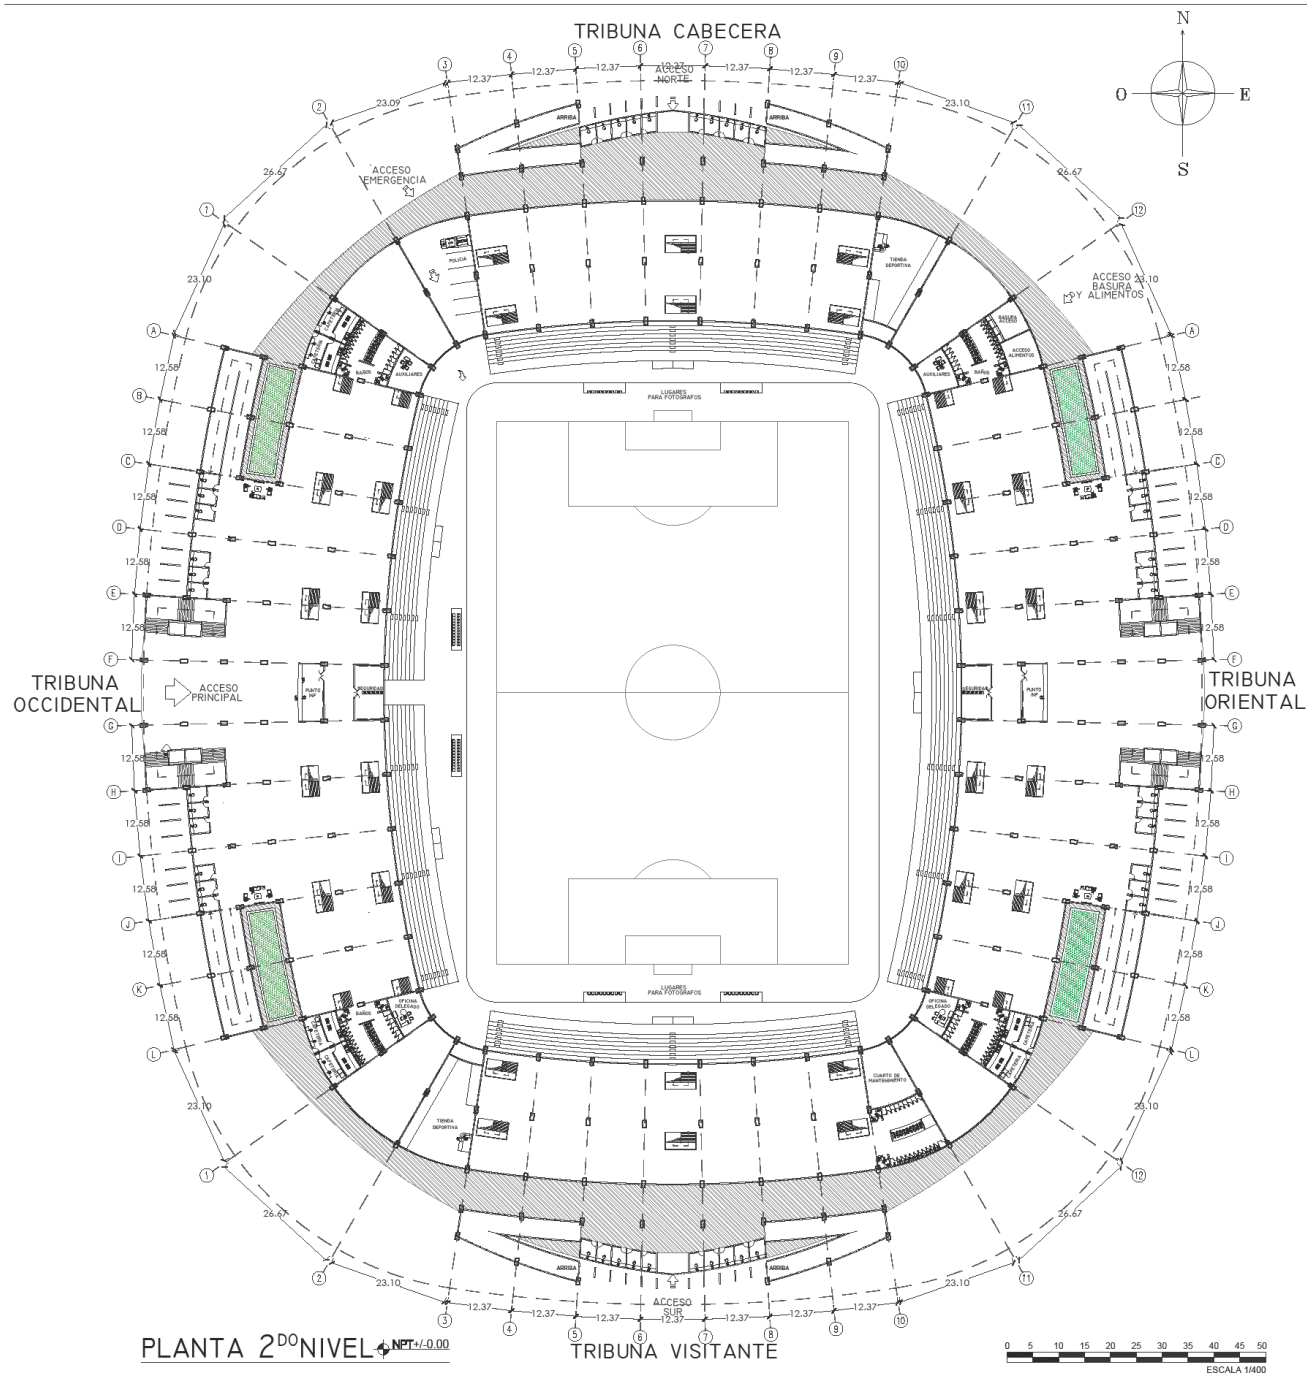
Planta 2 / Fuente Elaboración Propia
